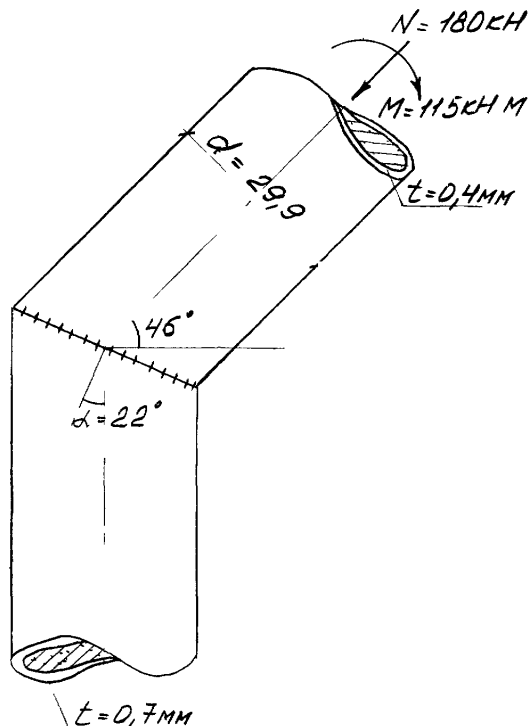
Конструкція опорного вузла трубобетонної арки.
